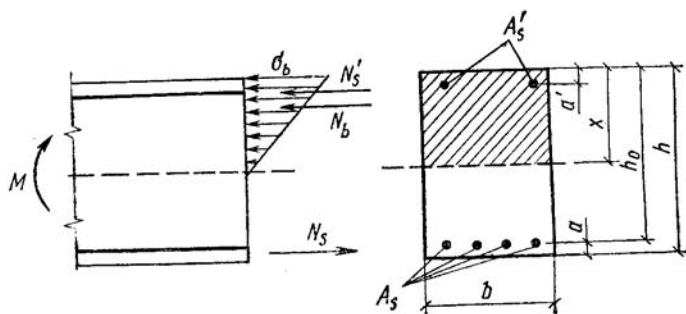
К расчету балки прямоугольного сечения по допускаемым напряжениям
